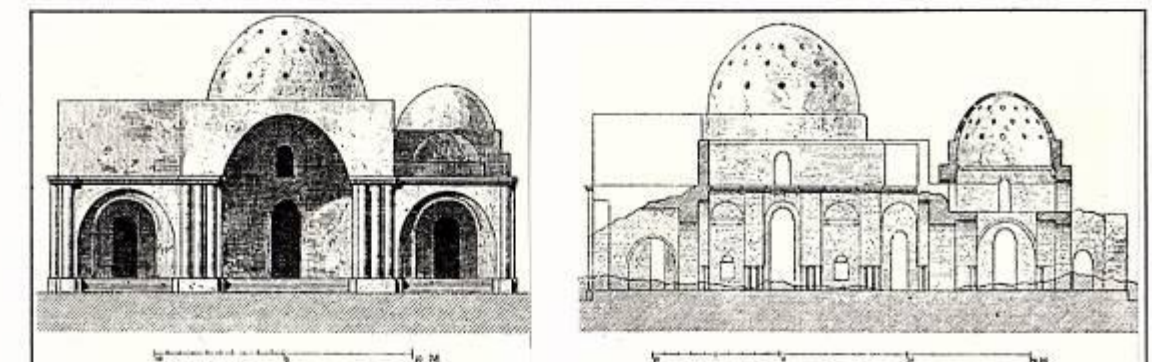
Façade principale et coupe longitudinale du palais de Sarwistan, (D'après PERROT et CHIPIEZ, 1.37).
